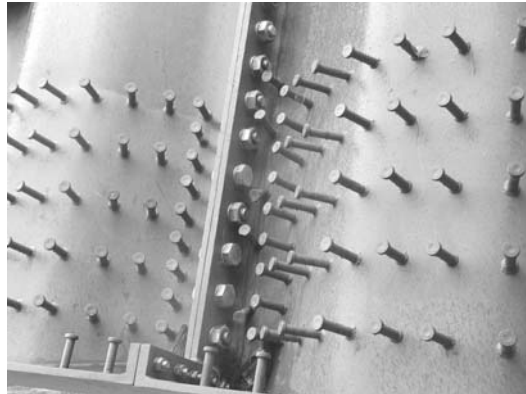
Detailansicht Untergurtanschluss an Kastenboden
